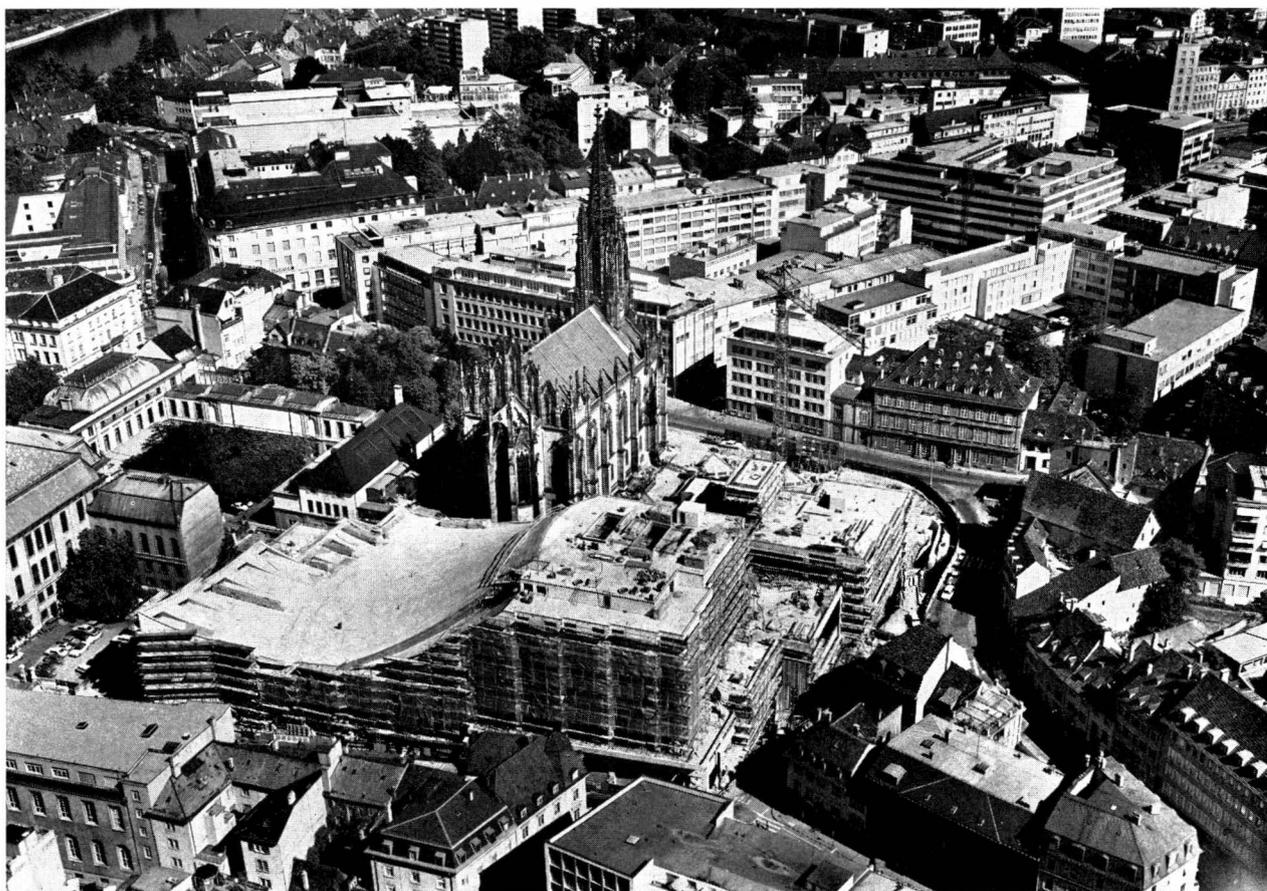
Flugaufnahme des fertig betonierten Daches.
